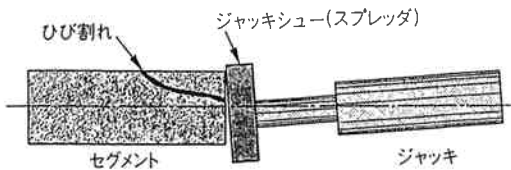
ジャッキシュアの不良によるひび割れ発生^リ
